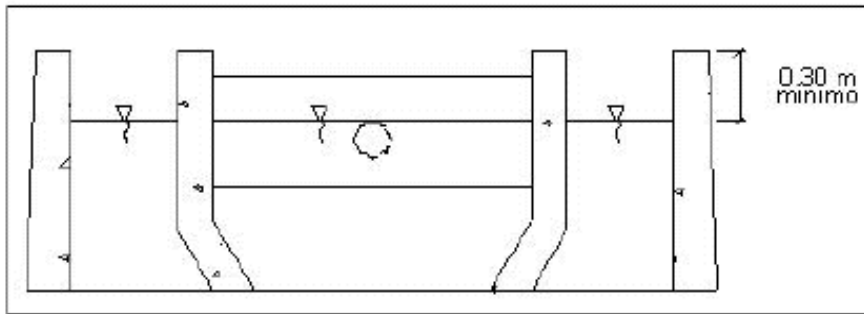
Vista transversal de la ventilación del tanque Imhoff
